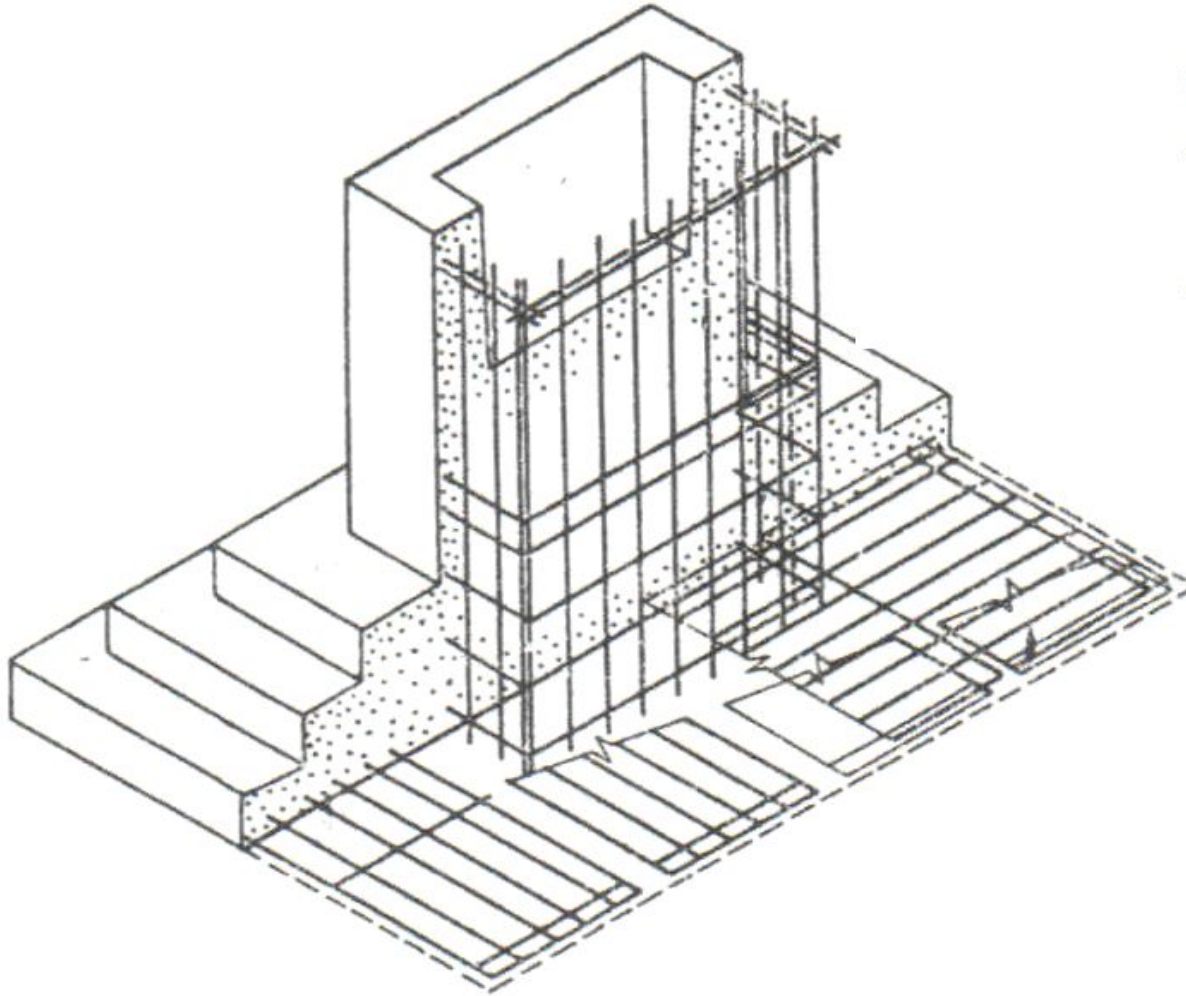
Составной железобетонный фундамент из сборных элементов.
